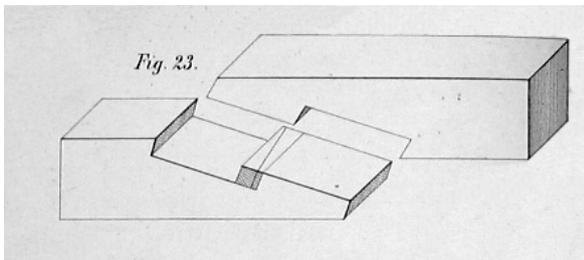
Das schräge Hakenblatt mit oder ohne Keil<sup>6</sup>
